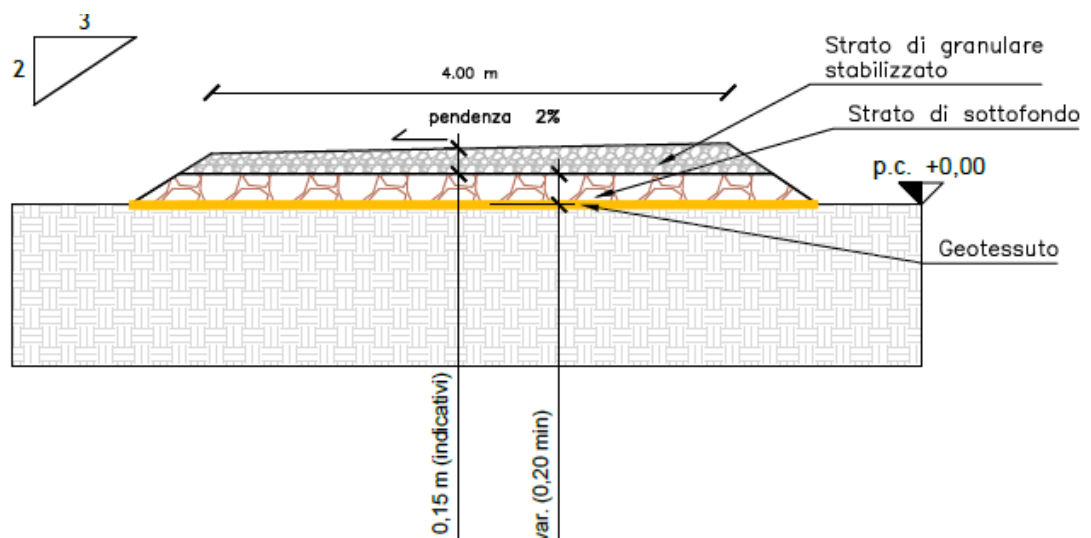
Tipologico sezione stradale viabilità d'impianto.
